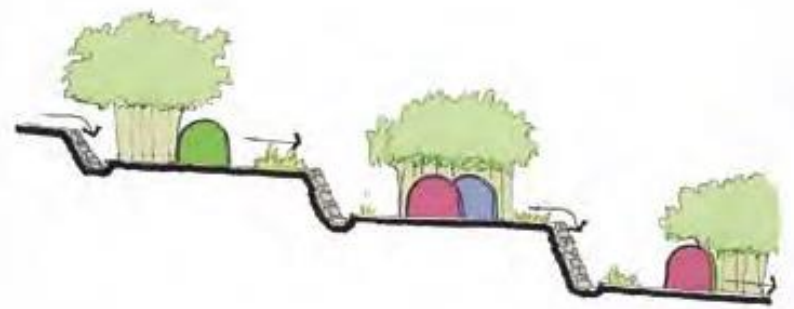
Zona de acampado en terrazas, construcción de muretes y canaletas para conducción de agua.
